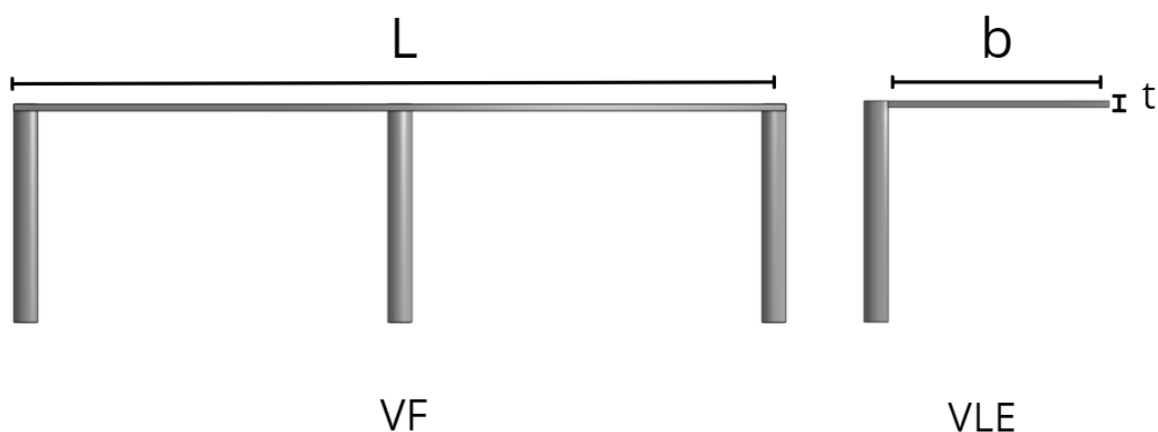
Vista frontal e lateral esquerda da estrutura plana
